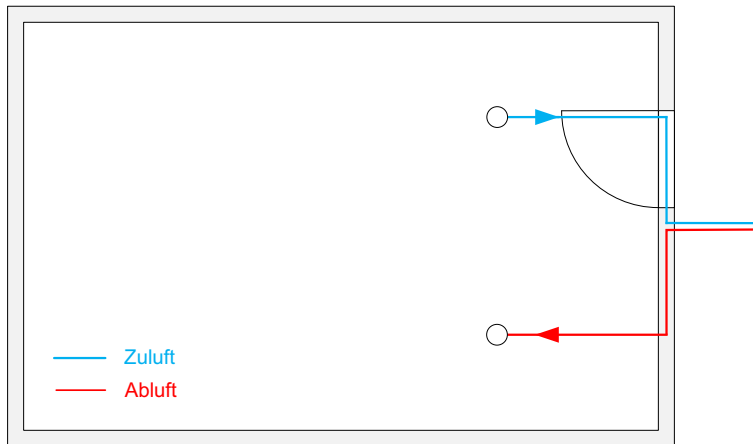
Horizontaler Schnitt - Grundschemata der Leitungsführung der Lüftung eines Standardraumes⁵¹⁴
